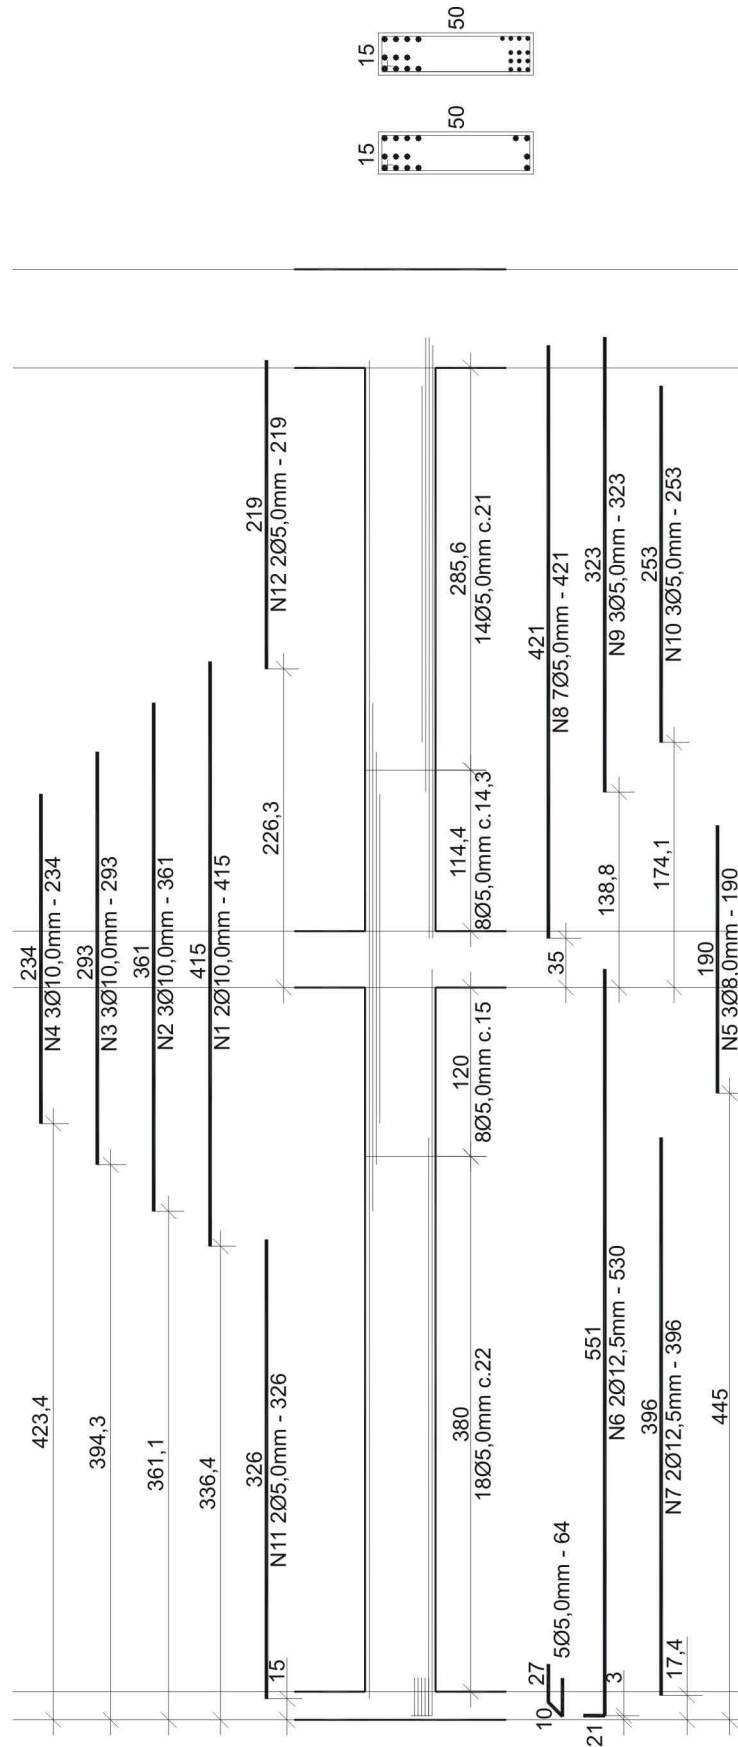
Detalhamento Viga 03.7, realizado pelo VigaCalc.
